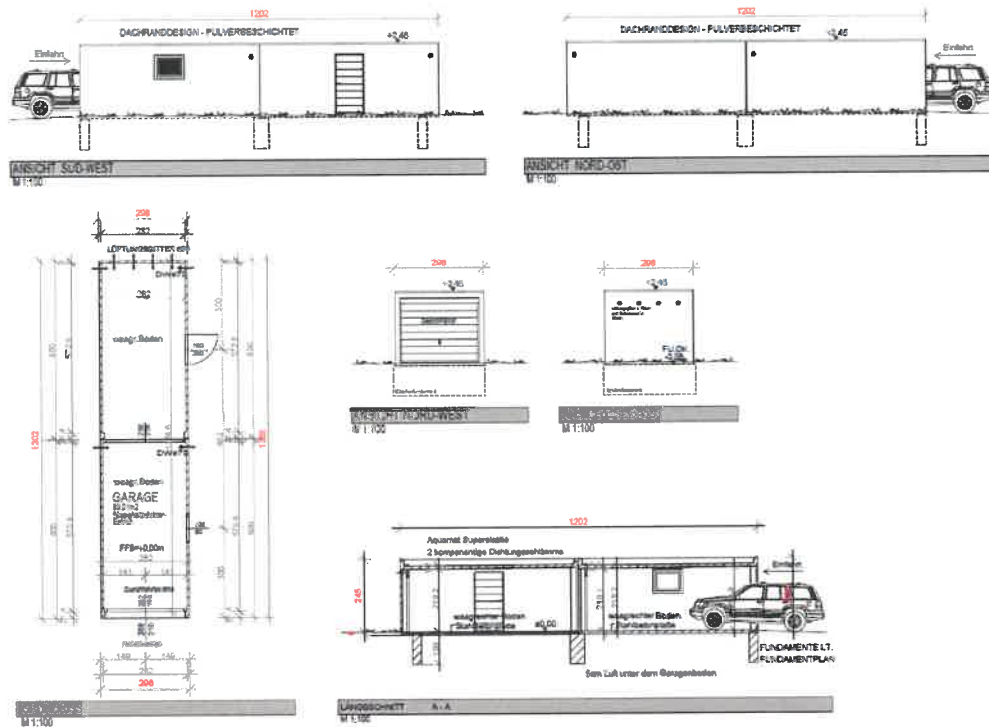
Detailplan der geplanten Garage laut Antragsteller (Quelle: TFM Bau GmbH vom 22.04.2021).
